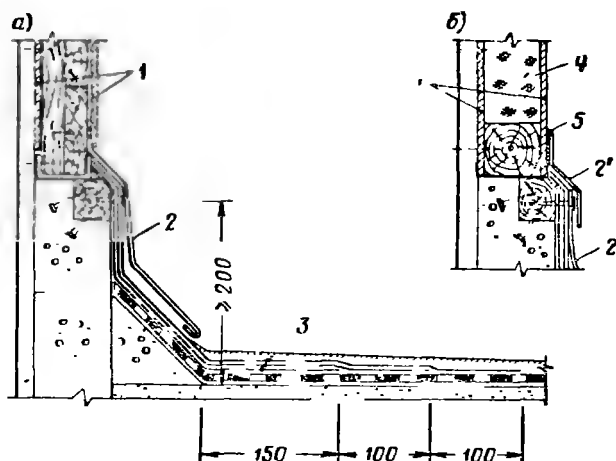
Примеры устройства кровель у примыканий к обшивкам вентиляционных шахт с асбестоцементными листами
